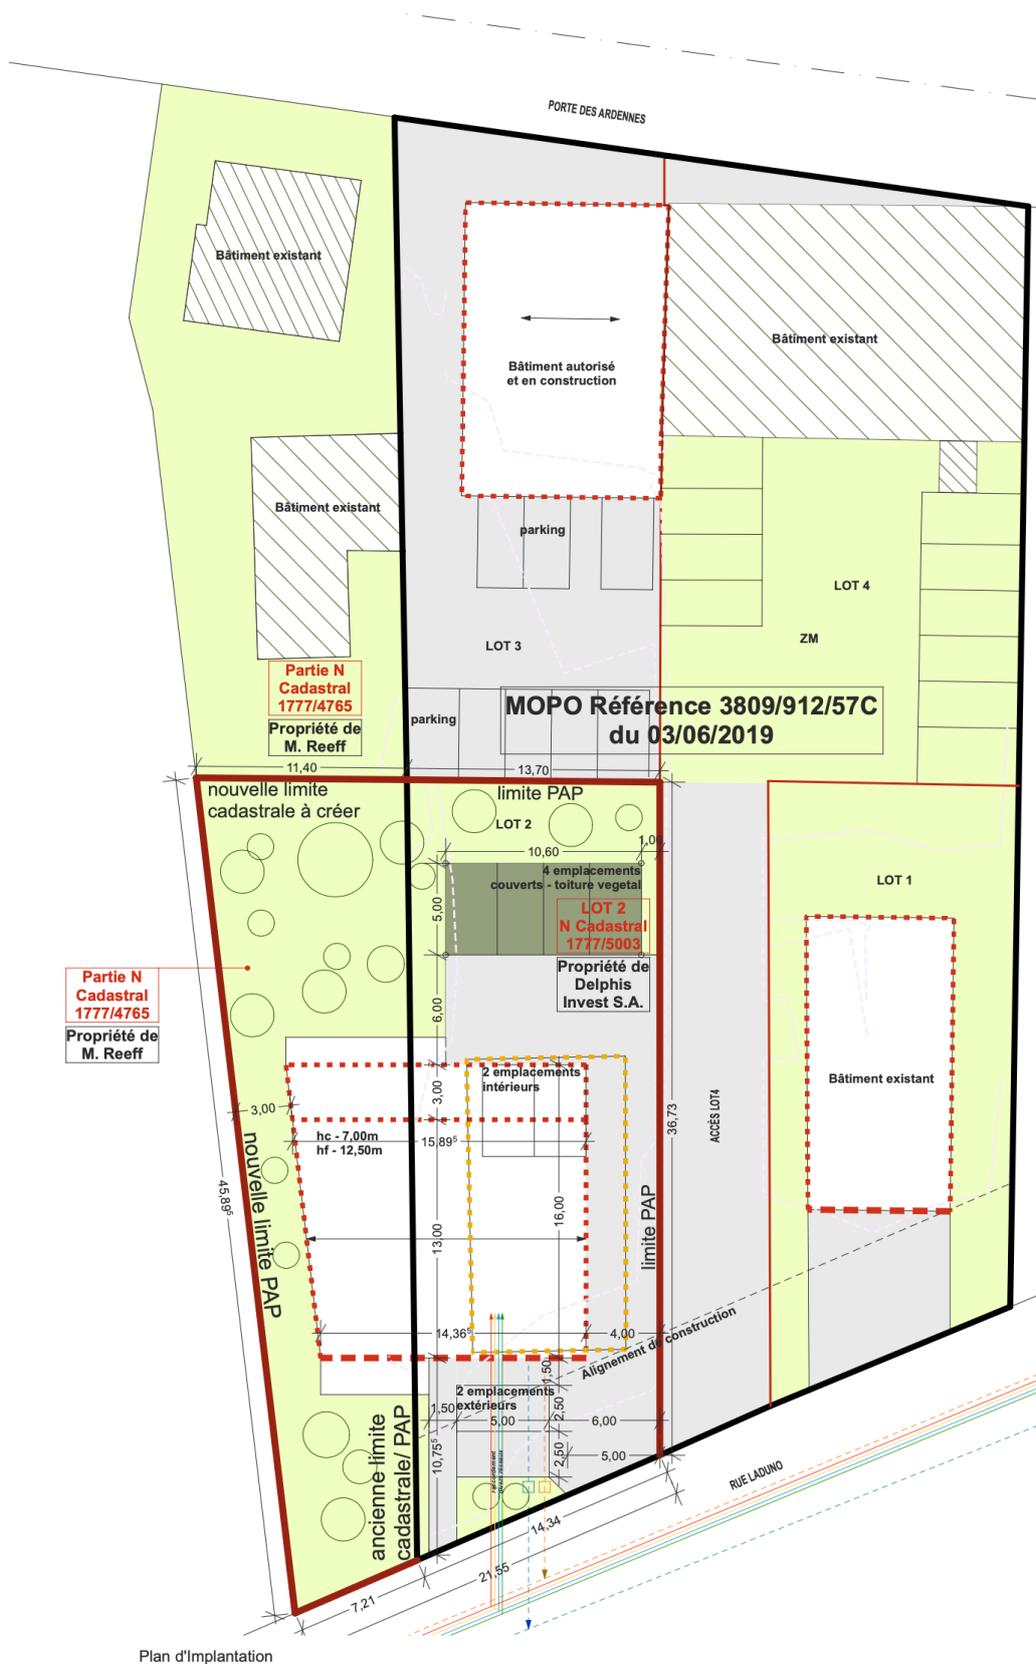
Plan dressé par Architecte Speicher Marc, Septembre 2023
